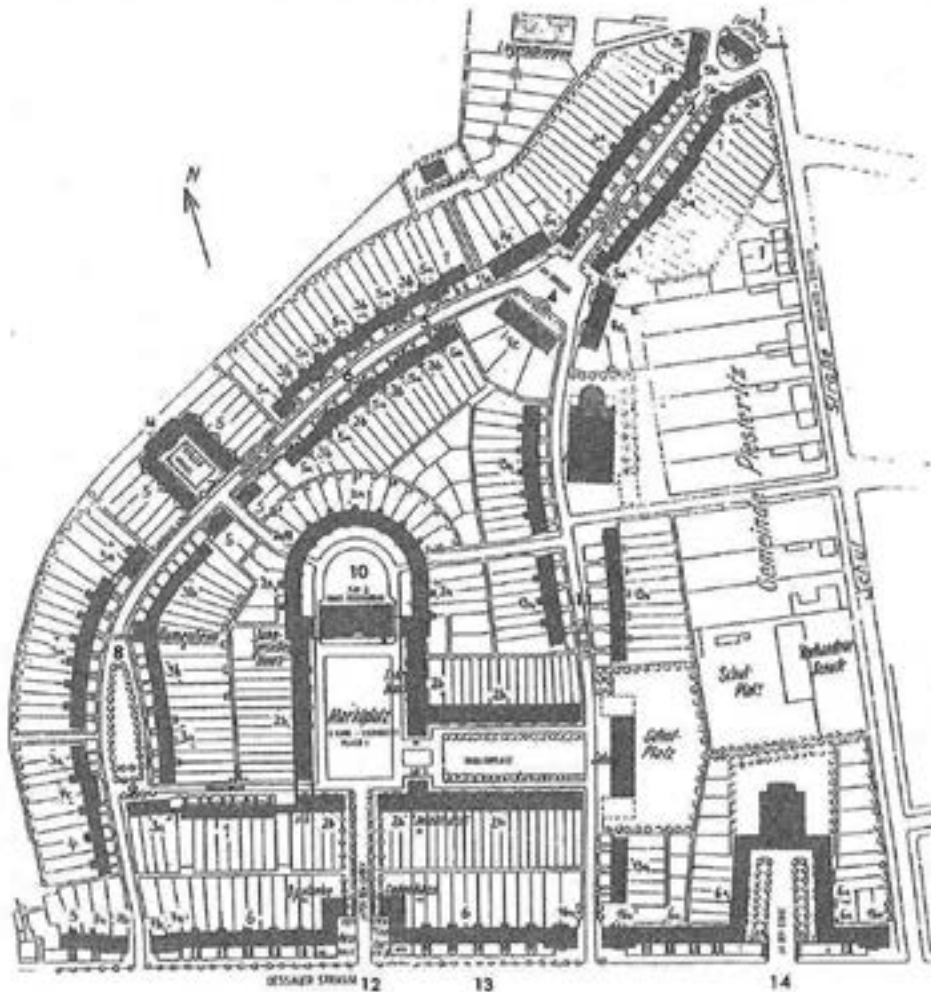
Lageplan der Siedlung Piesteritz (Grafik: Lutherstadt Wittenberg)
